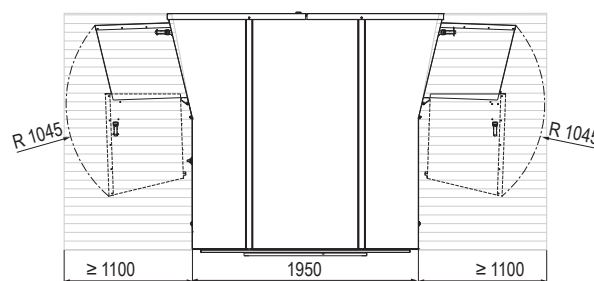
Espace nécessaire pour la maintenance sur la toiture (dimensions en mm)
